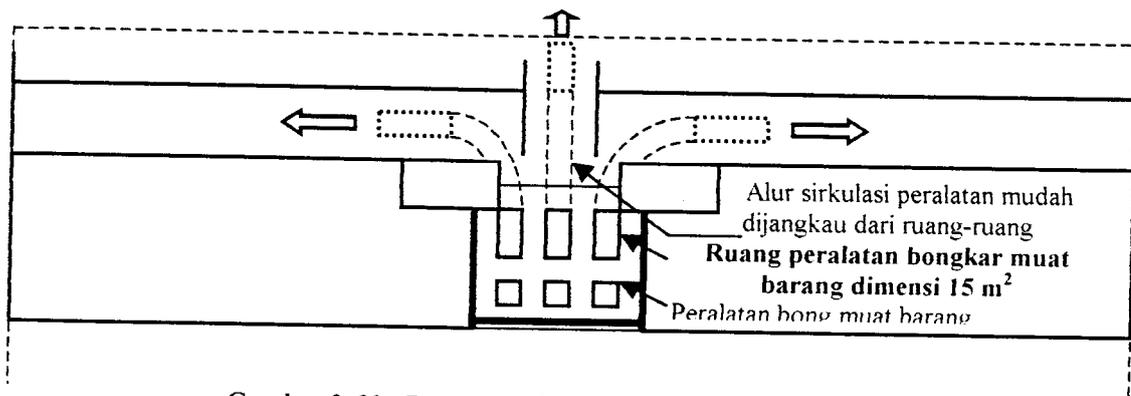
Ruang-ruang sirkulasi pada lantai atas
